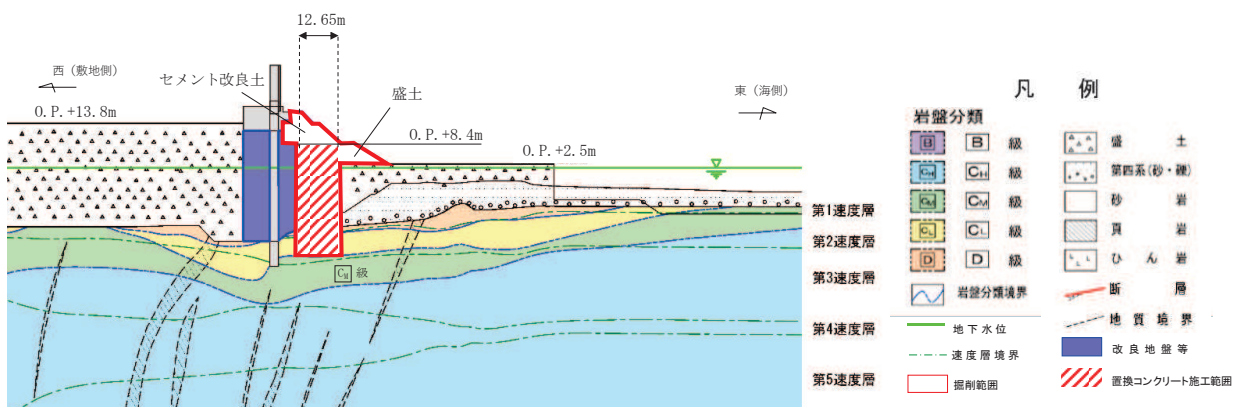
(2) 置換コンクリートの施工範囲図（断面図）
